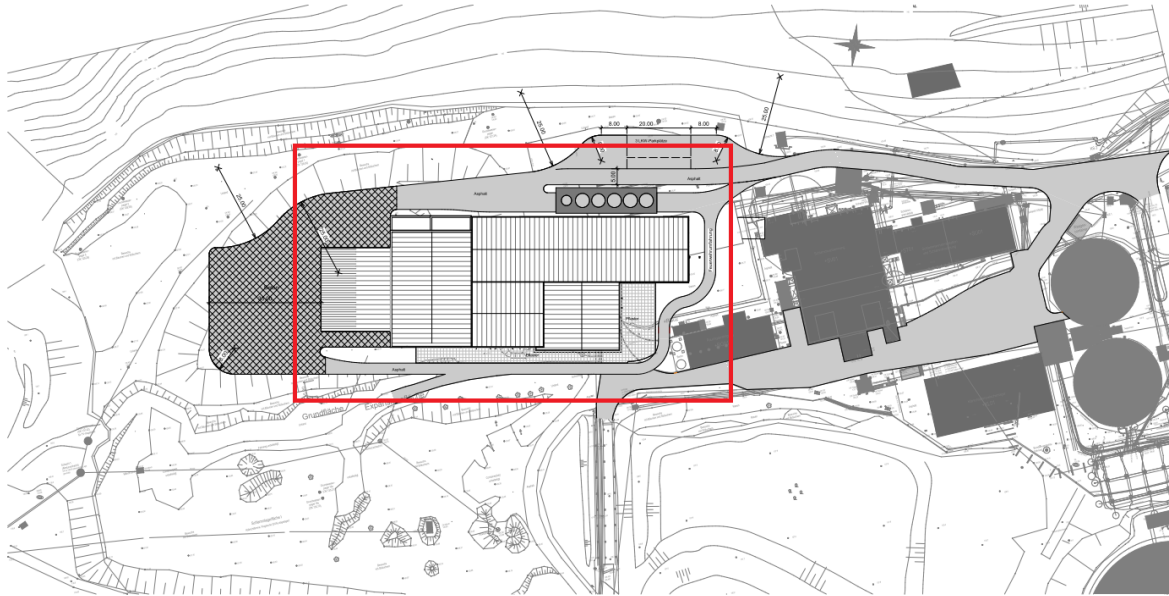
Lageplan [Quelle: Entwurfsbericht S.244]
